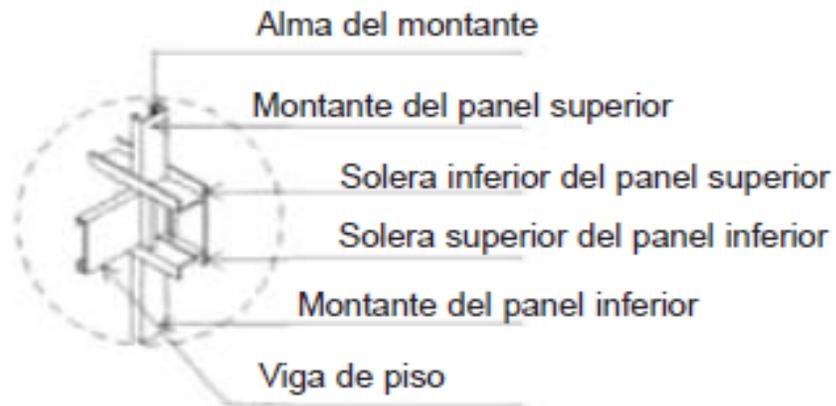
Transmisión de la carga vertical a la fundación.
